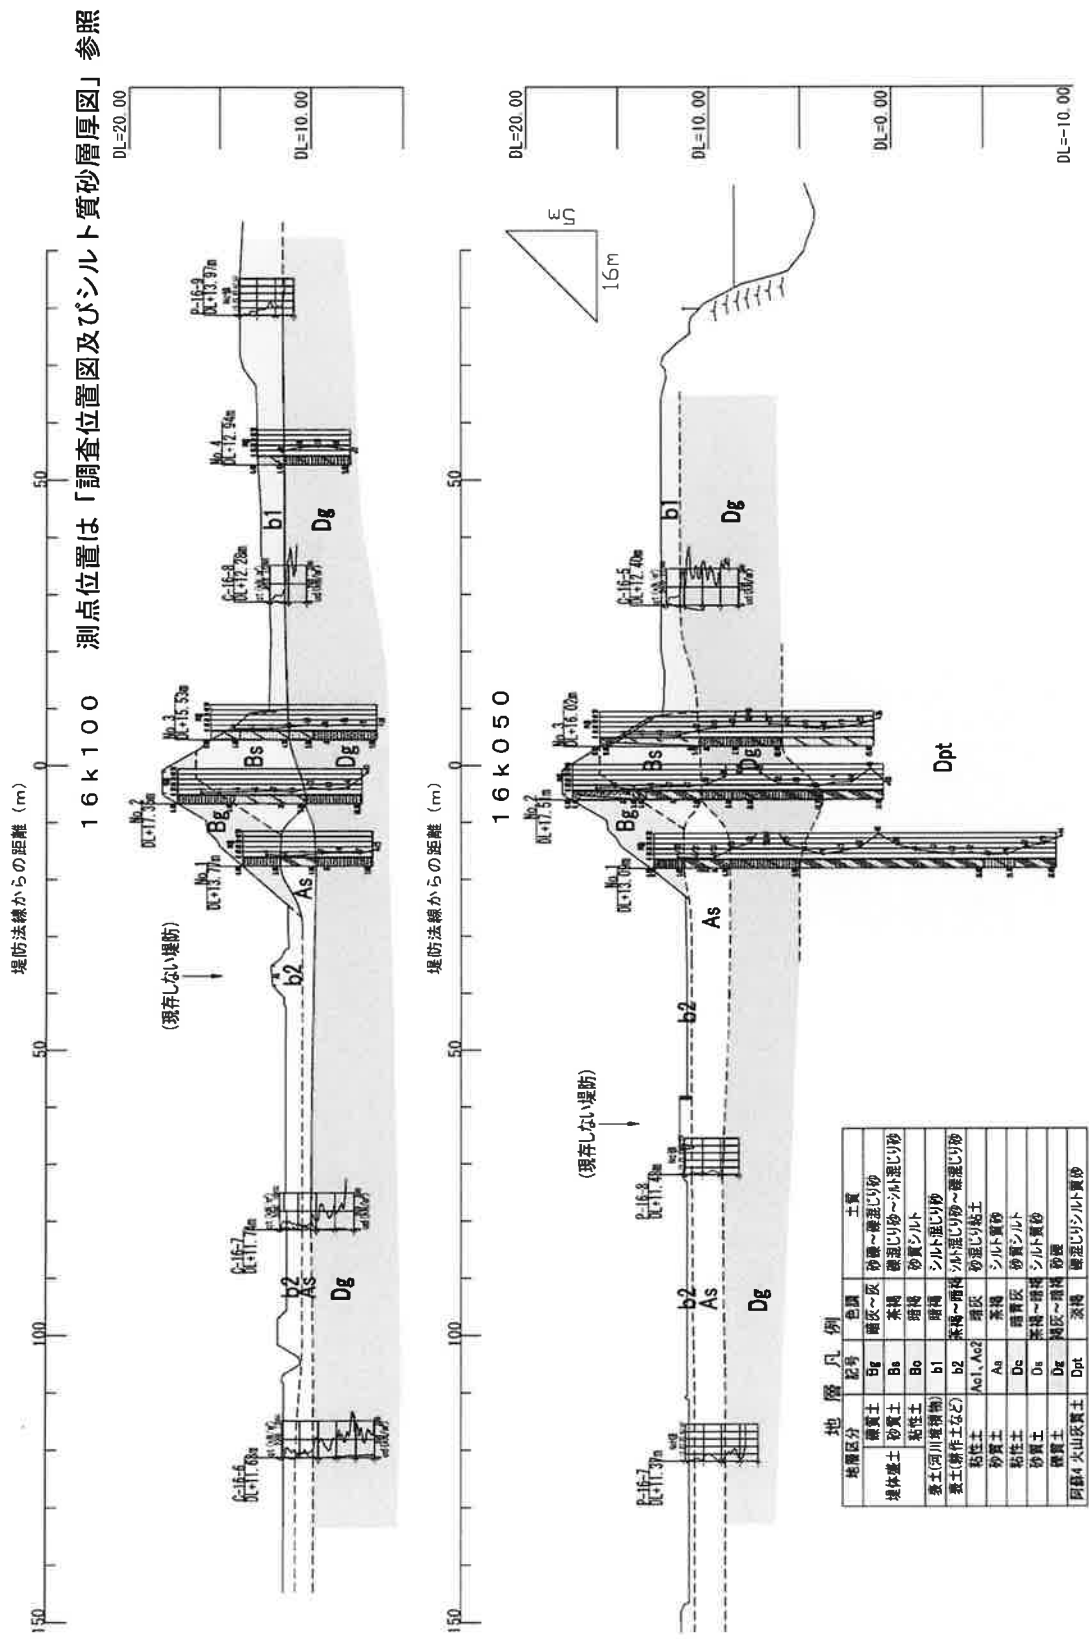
4. 13 推定地層断面図 (左岸 16.0k 付近) (縮尺 SV : SH=1/250 : 1/800) (被災断面)
